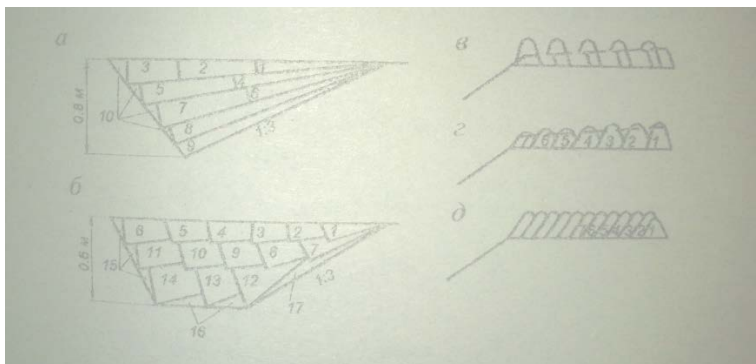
Схемы разработки автогрейдерами боковых резервов:
